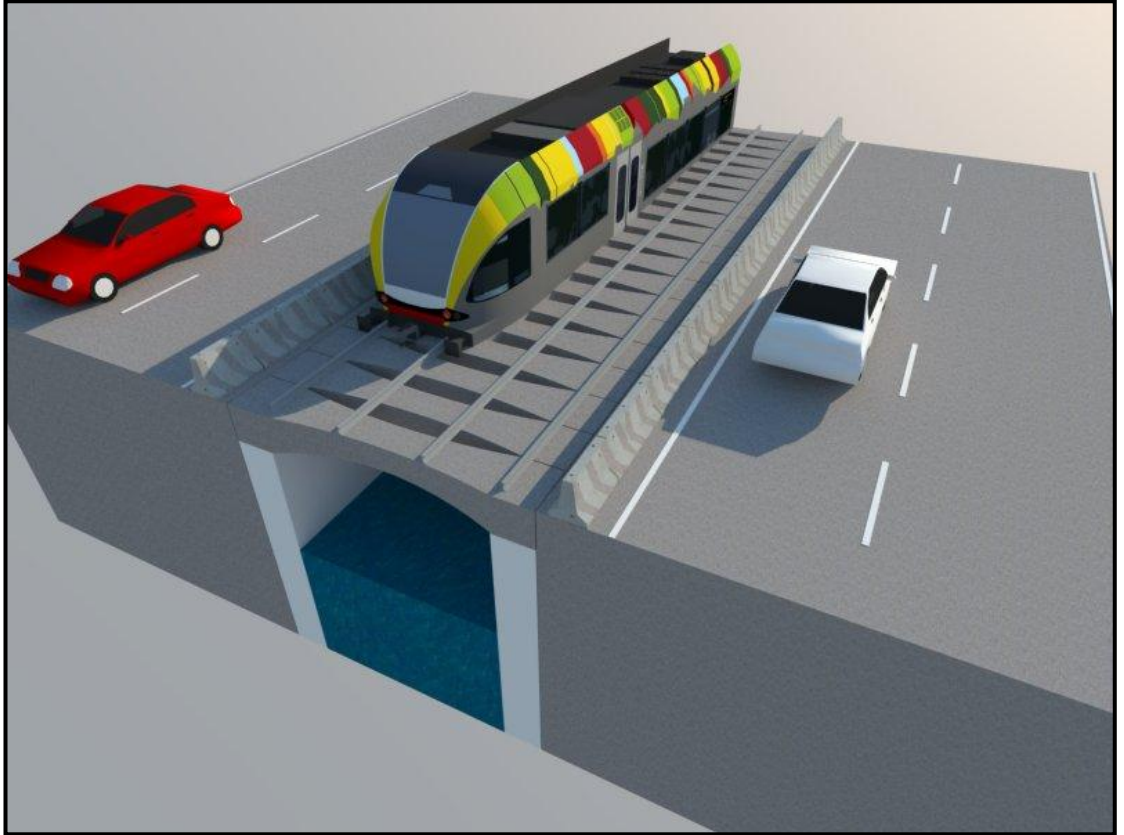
Prekast sistemle hazırlanmış beton bloklar
